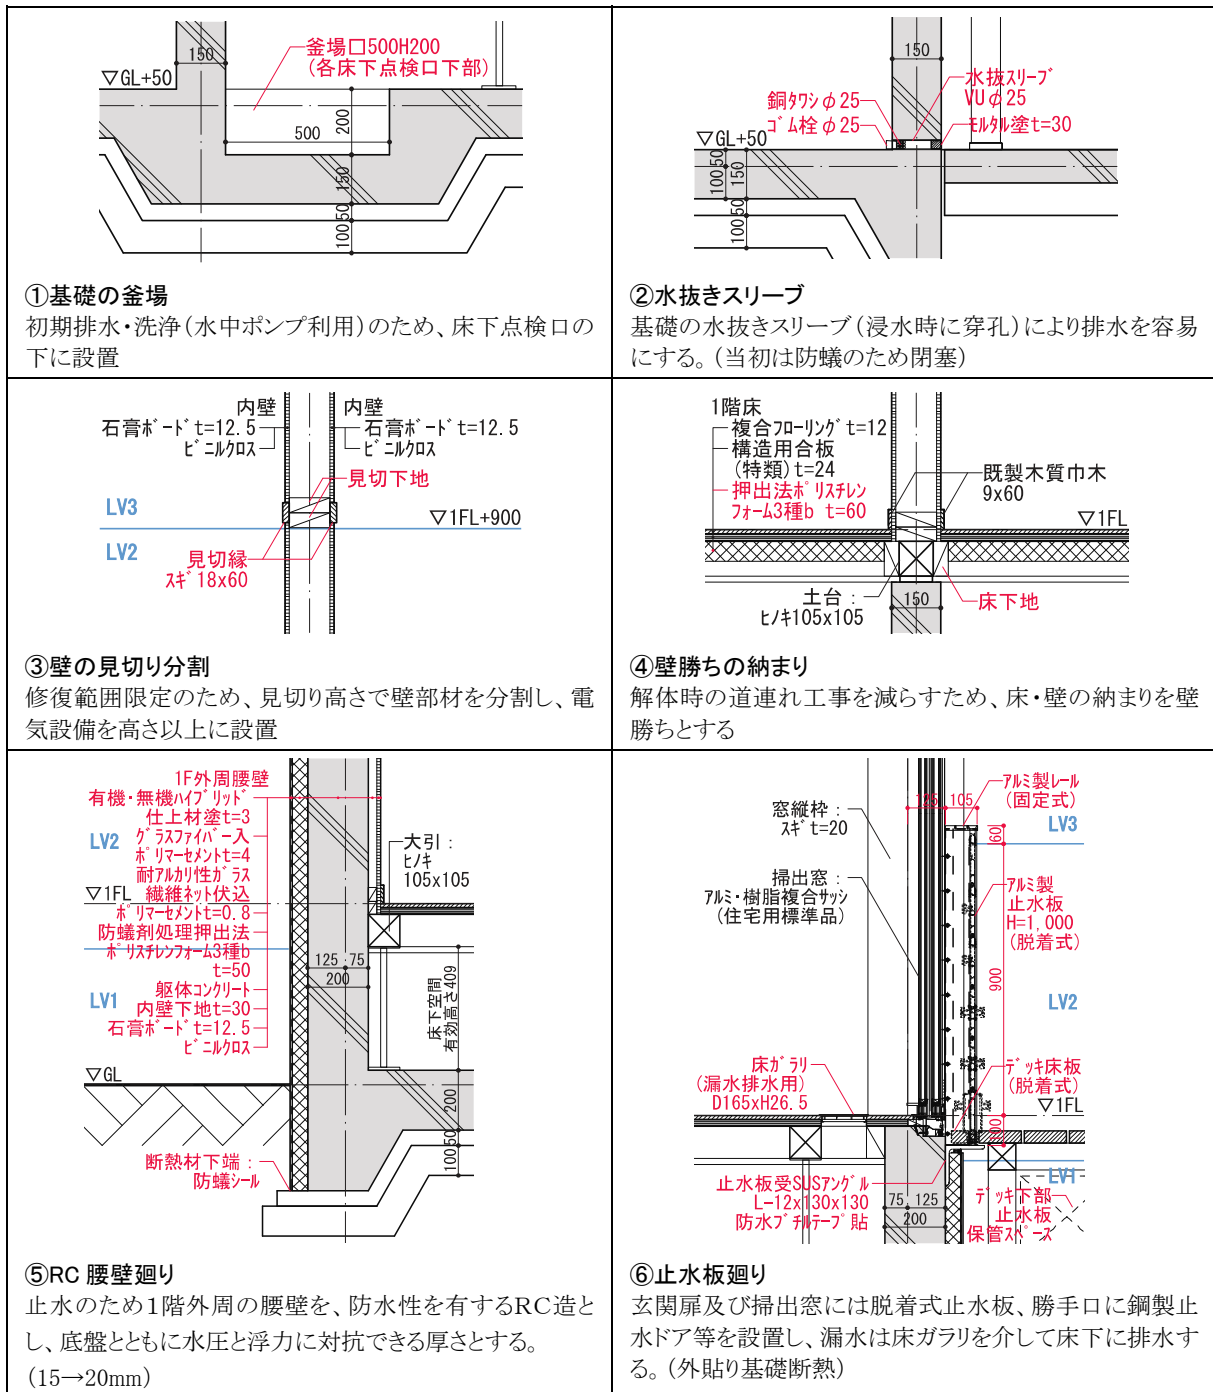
各案の浸水対策に係わる詳細拡大図 (丸数字は図 II-15 断面図に対応)
